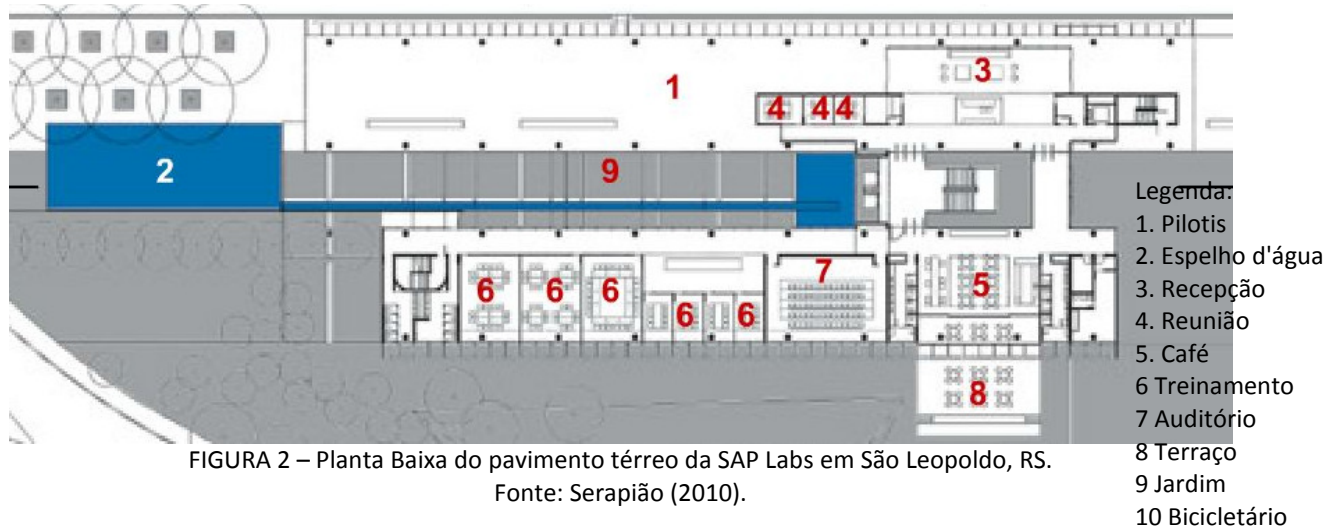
Planta Baixa do pavimento térreo da SAP Labs em São Leopoldo, RS.
